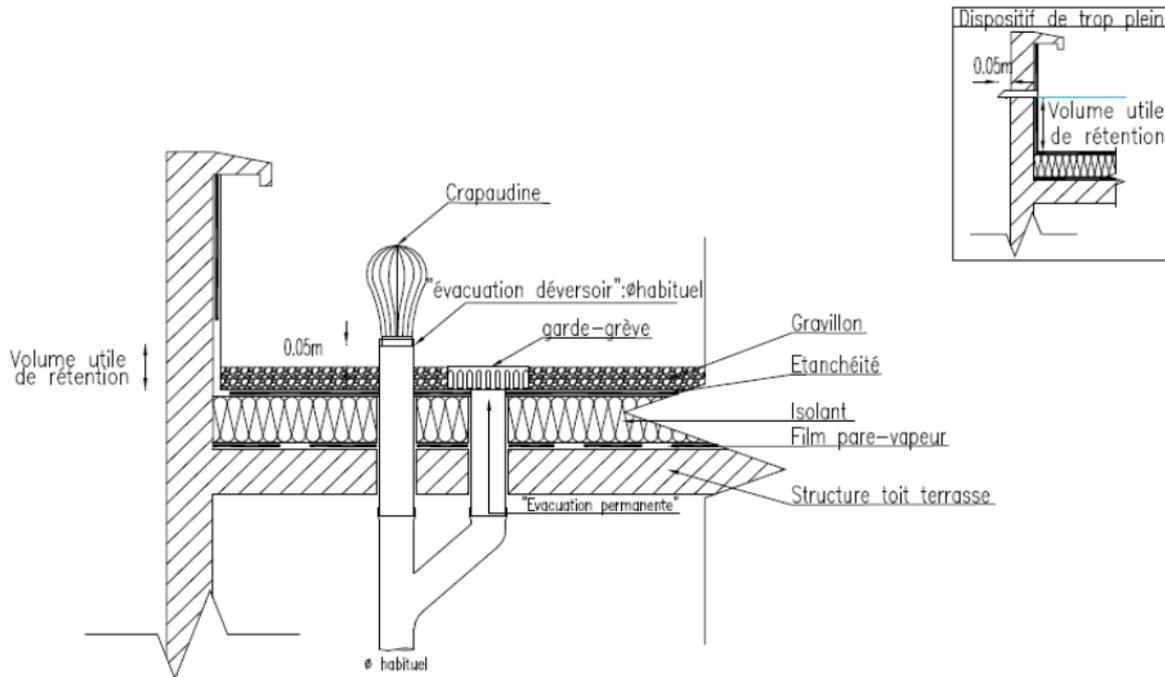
Vue en coupe d'un ouvrage de gestion des eaux de toiture
